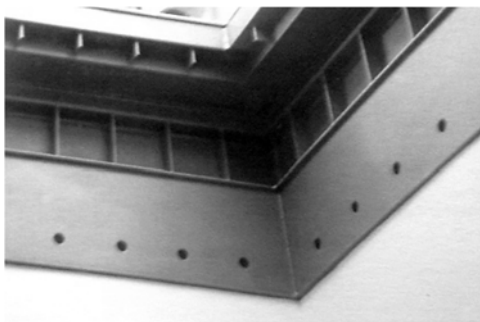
Alero del patio. Fuente: 10 años de arquitectura.
